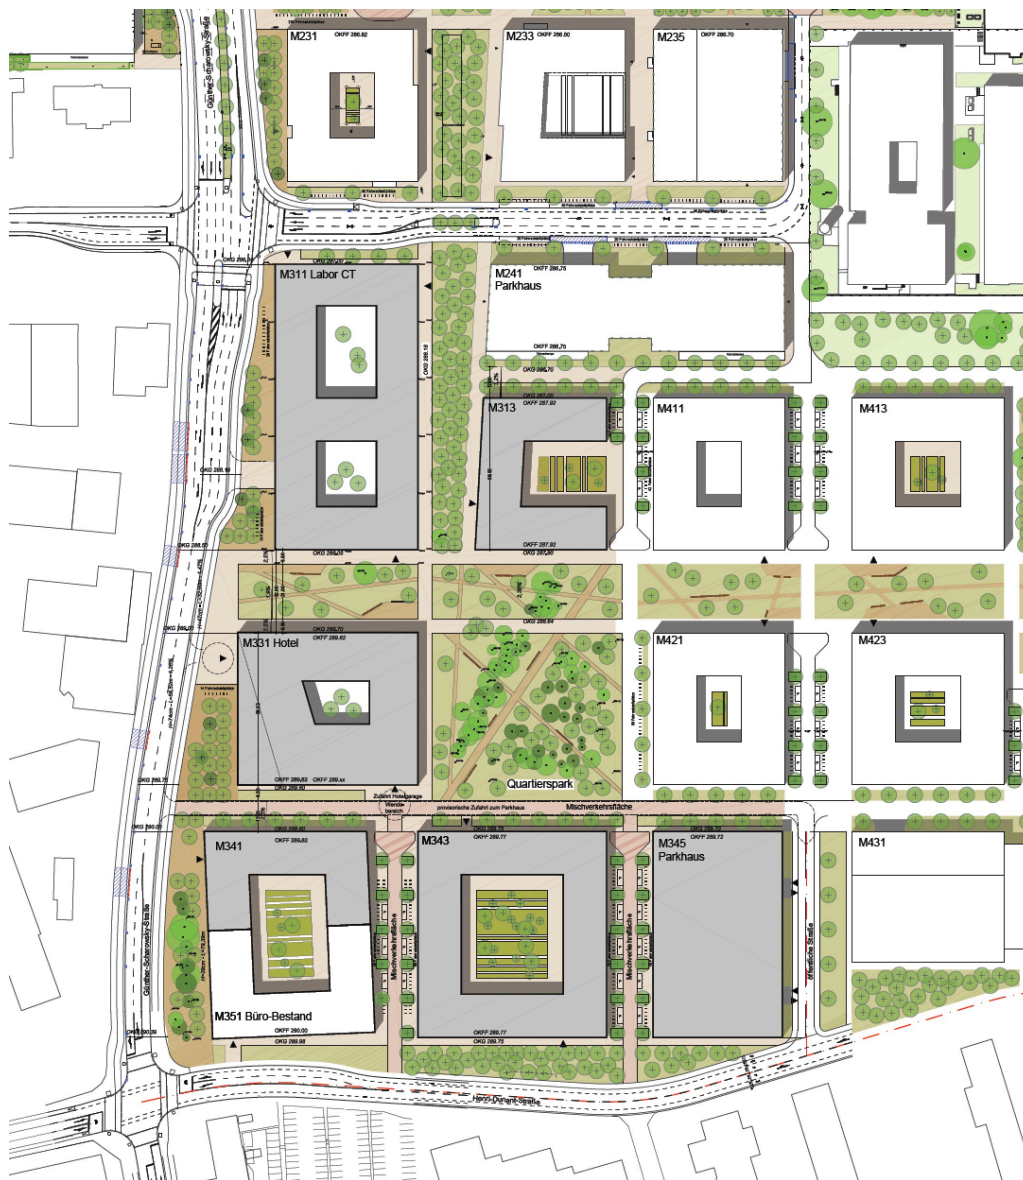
Ausschnitt aus dem Masterplan „Siemens Campus Erlangen“, Stand 13.12.2017
